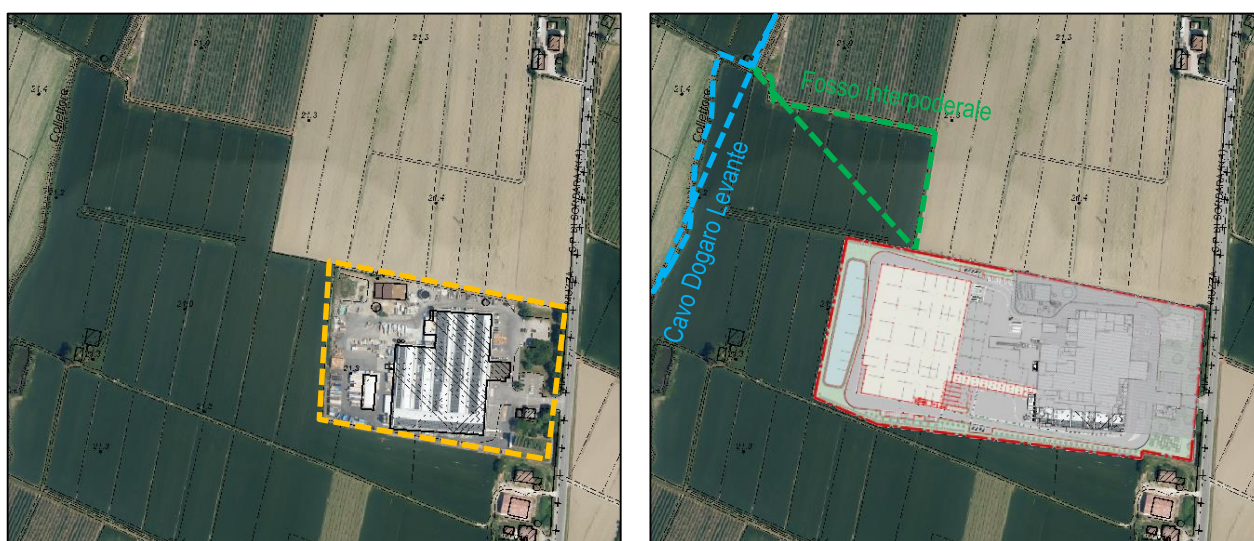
Stralcio Ortofoto Stato di fatto e Layout di Progetto
